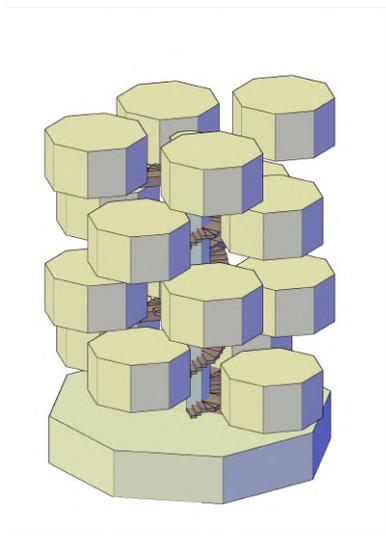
Baumkonstruktion mit zentralem Leitungsschacht und Treppenhaus (Quelle: Hörnlein).
